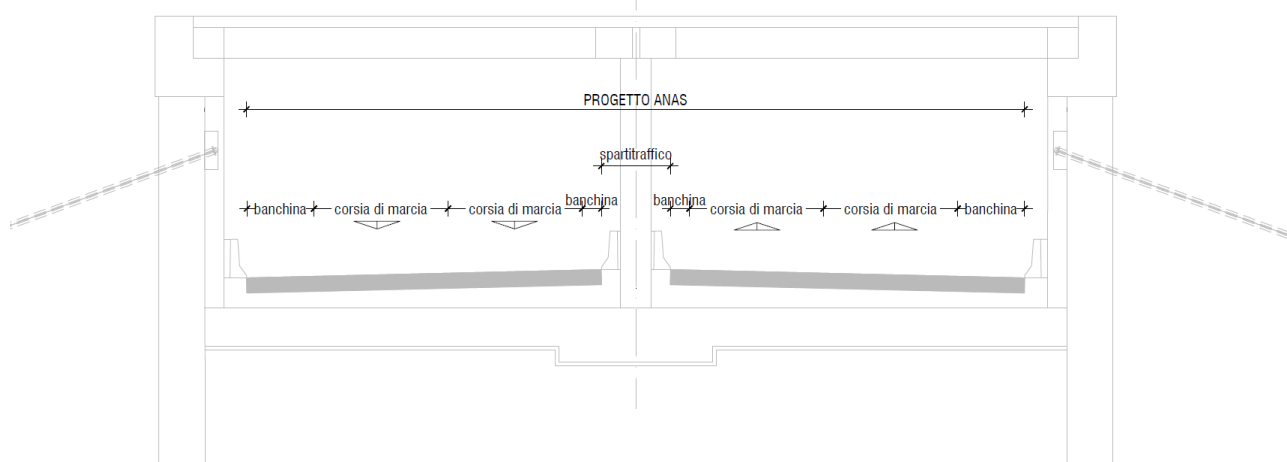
Viabilità di progetto in sotto-attraversamento (previa demolizione del rilevato)
